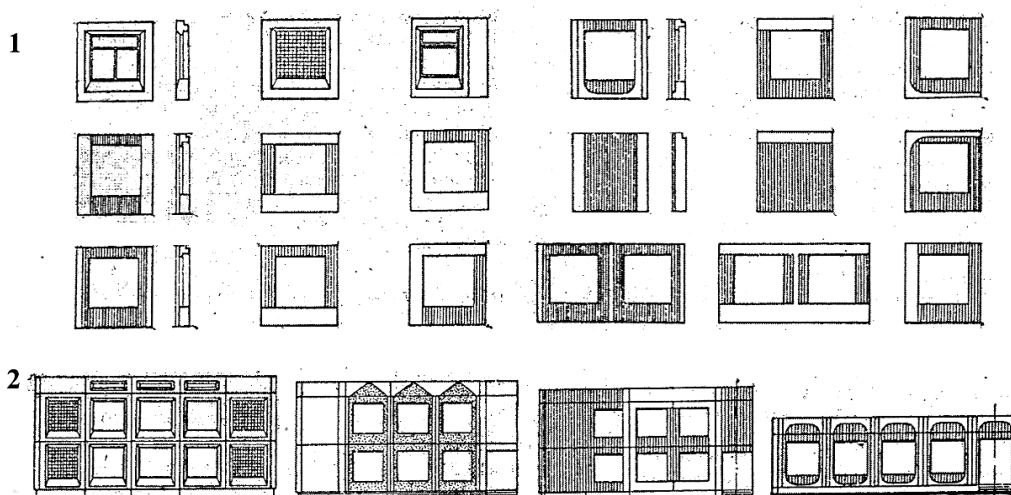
Примеры фасадной отделки панелей наружных стен:
